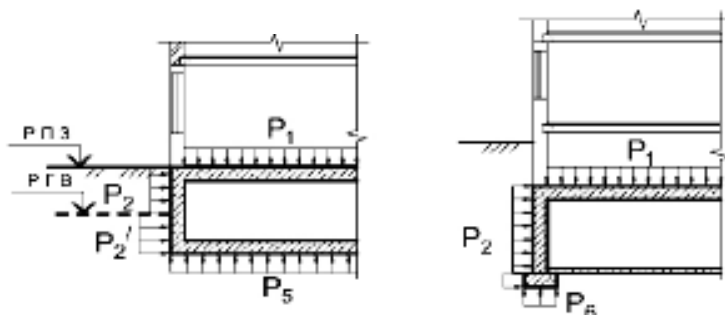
Схеми прикладання приведеного навантаження на фундамент захисних споруд
